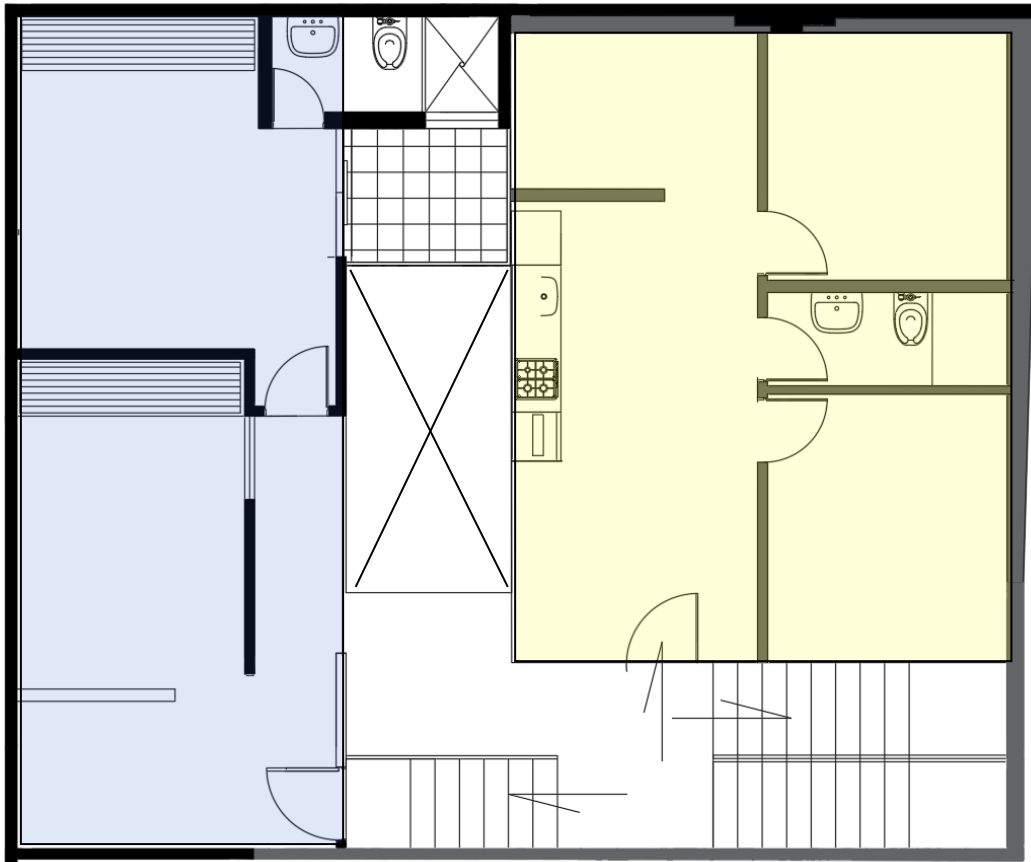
Primera planta actual. Fuente: elaboracion propia.
